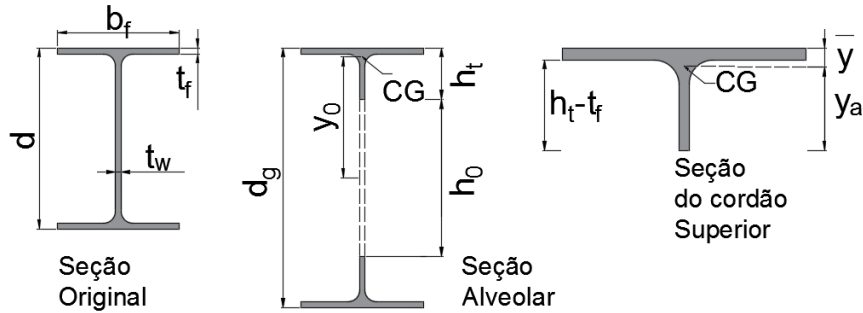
Simbologia dos elementos da seção transversal de vigas alveolares.
